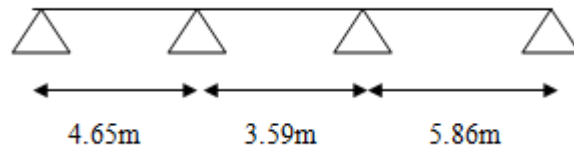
Schéma de 1<sup>er</sup> type de poutrelle
